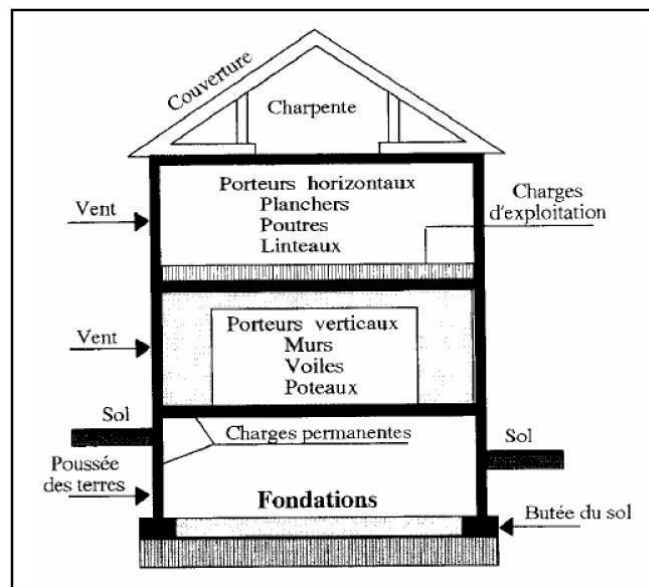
La structure porteuse transmet toutes ces charges au sol par l'intermédiaire des fondations
